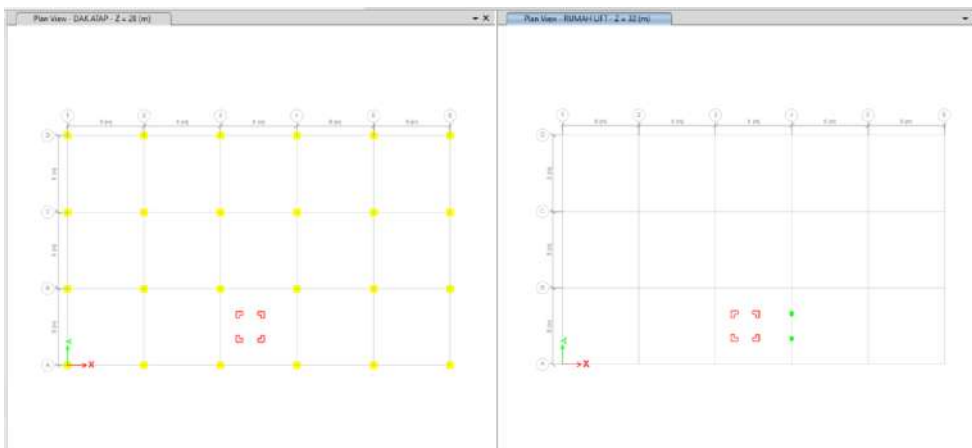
Denah Kolom Lantai 2 dan Lantai 3
